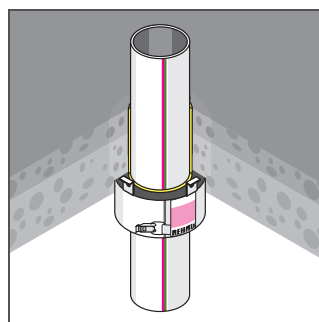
Противопожарная манжета для встраивания в перекрытие
